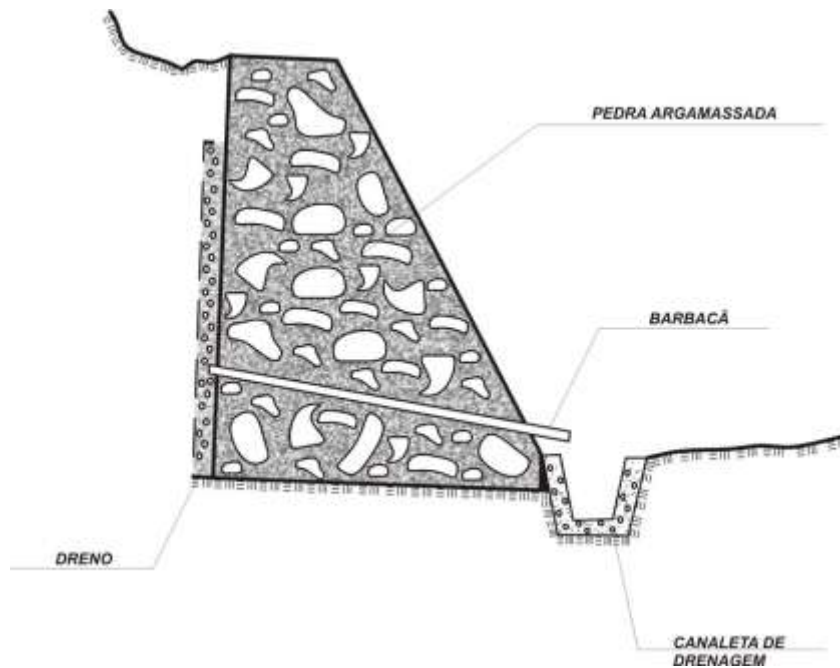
Projeto tipo 12 – Muro de peso de pedra argamassada.
